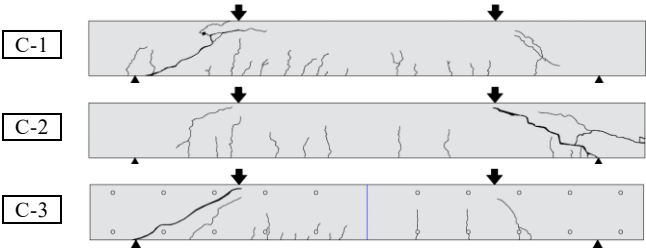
側面のひび割れ図 (C-1~3)
